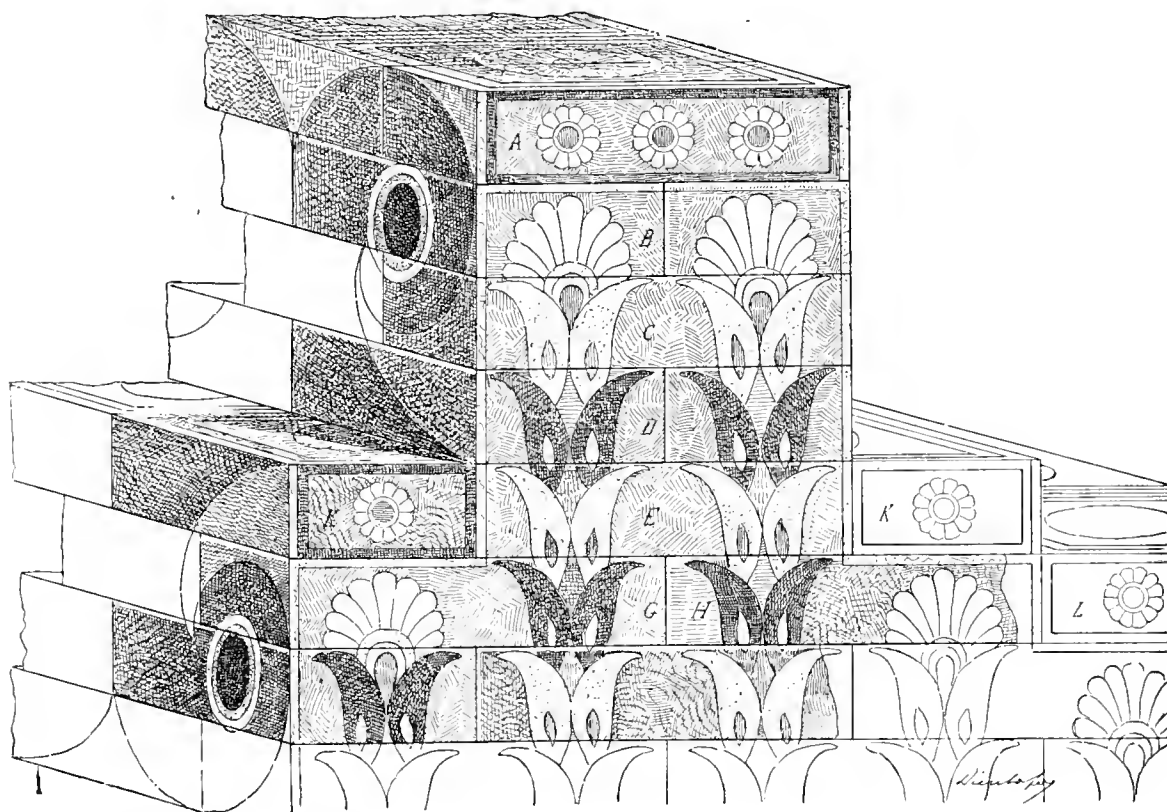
COURONNEMENT D'UNE RAMPE D'ESCALIER (FOUILLES DE SUSE).
